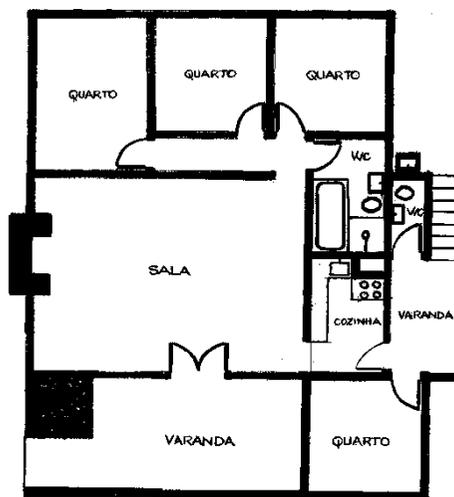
Planta baixa da Casa Scavone. Fonte: elaborado pelo autor com base na observação *in loco* das ruínas.
